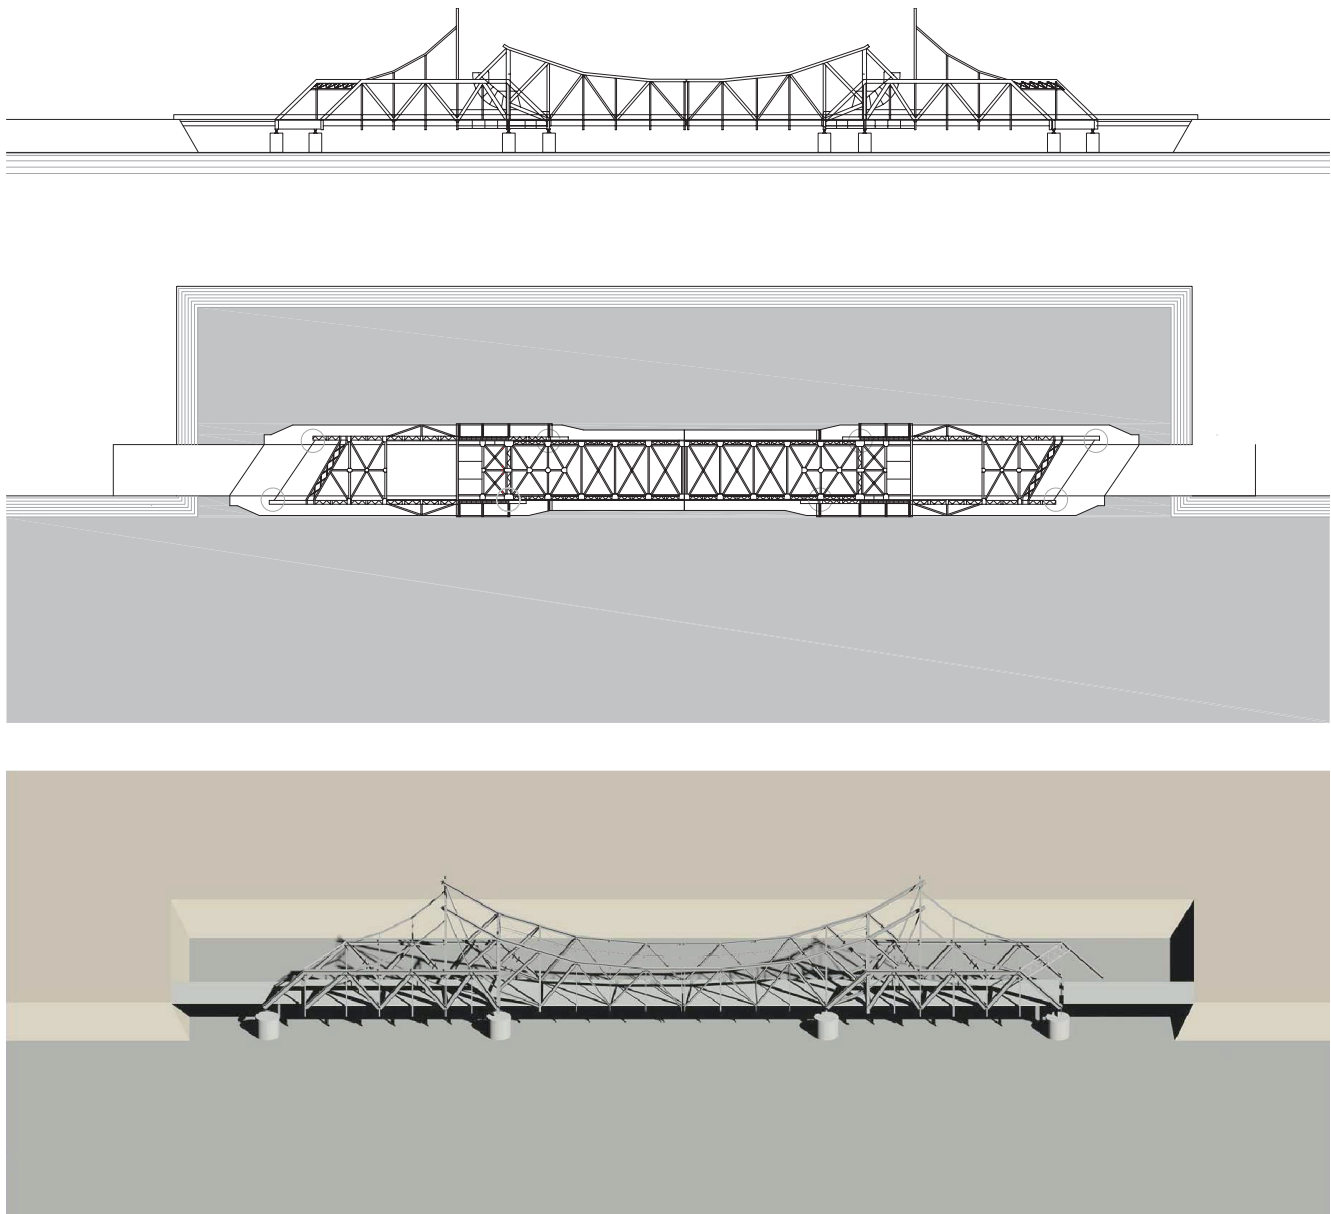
Planta alzado y axonometría de la propuesta de reubicación ocupando la margen del río. Posible piscina fluvial. Dibujo: Óscar Gil Sánchez-Carrasco.
